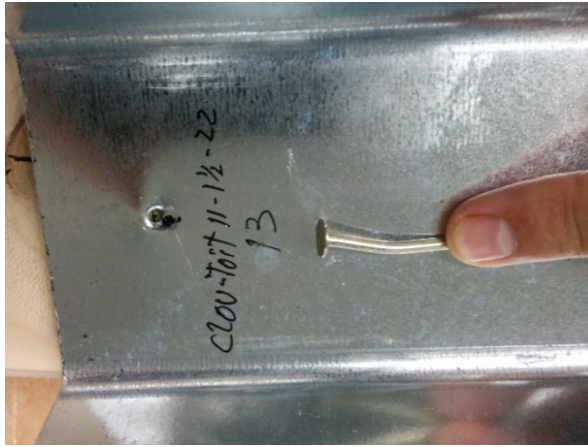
État du clou suite à la rupture de l'assemblage Clou toit #11 1-1/2-22-13
